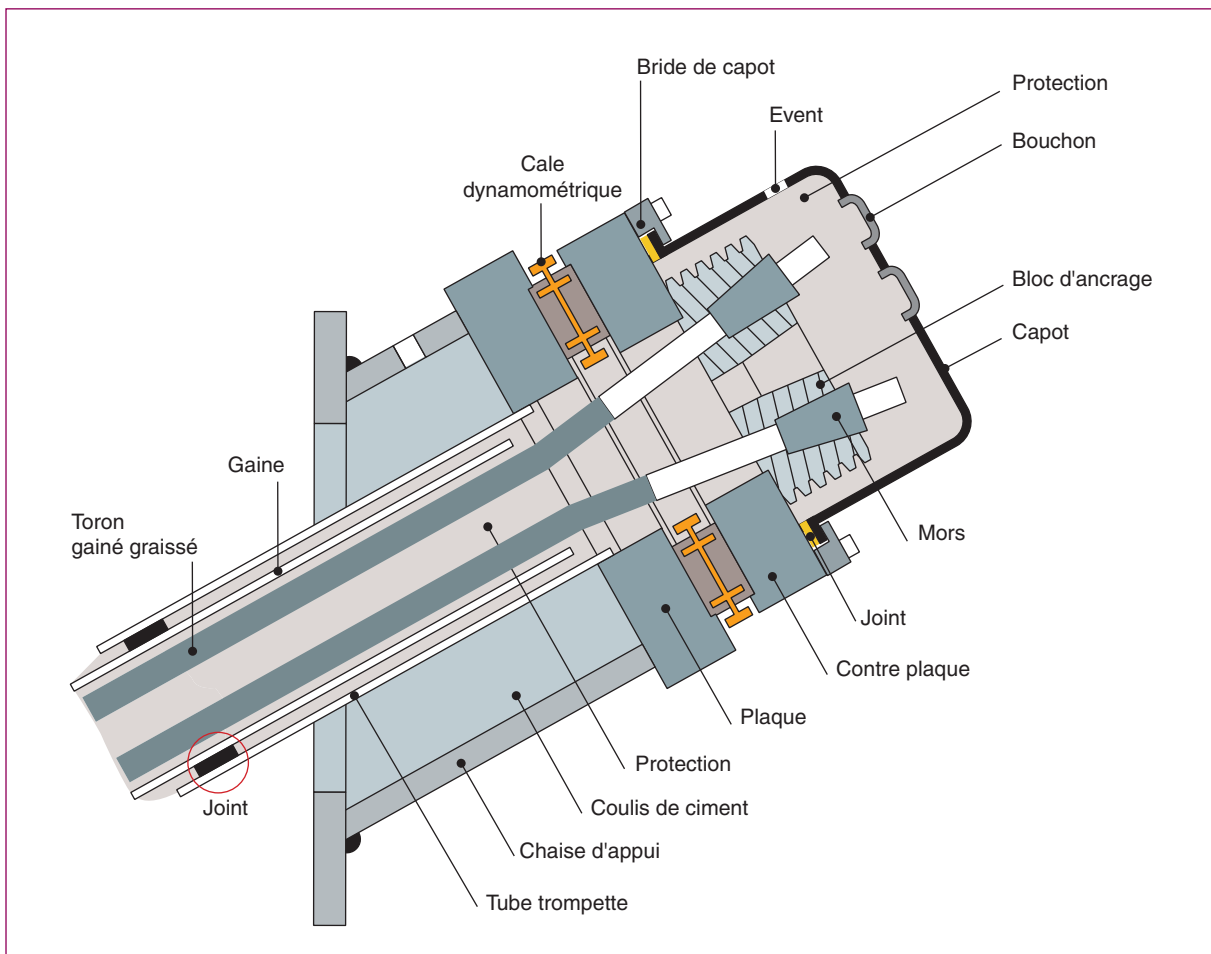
Tête d'ancrage avec capot de protection dépassant du parement.
